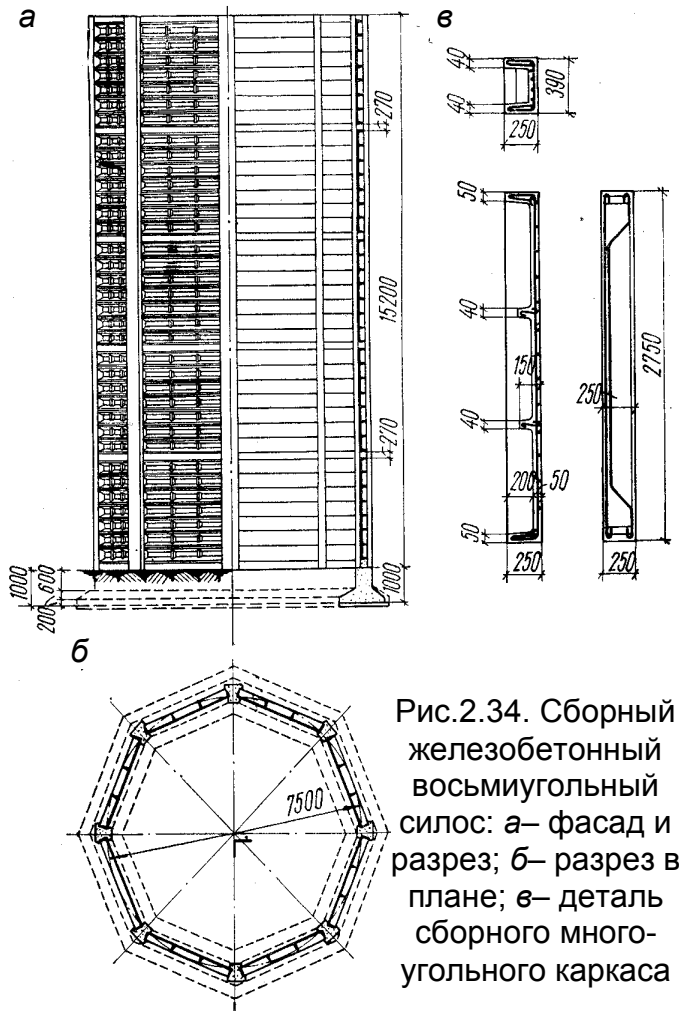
Сборный железобетонный восьмиугольный силос: а– фасад и разрез; б– разрез в плане; в– деталь сборного многоугольного каркаса
